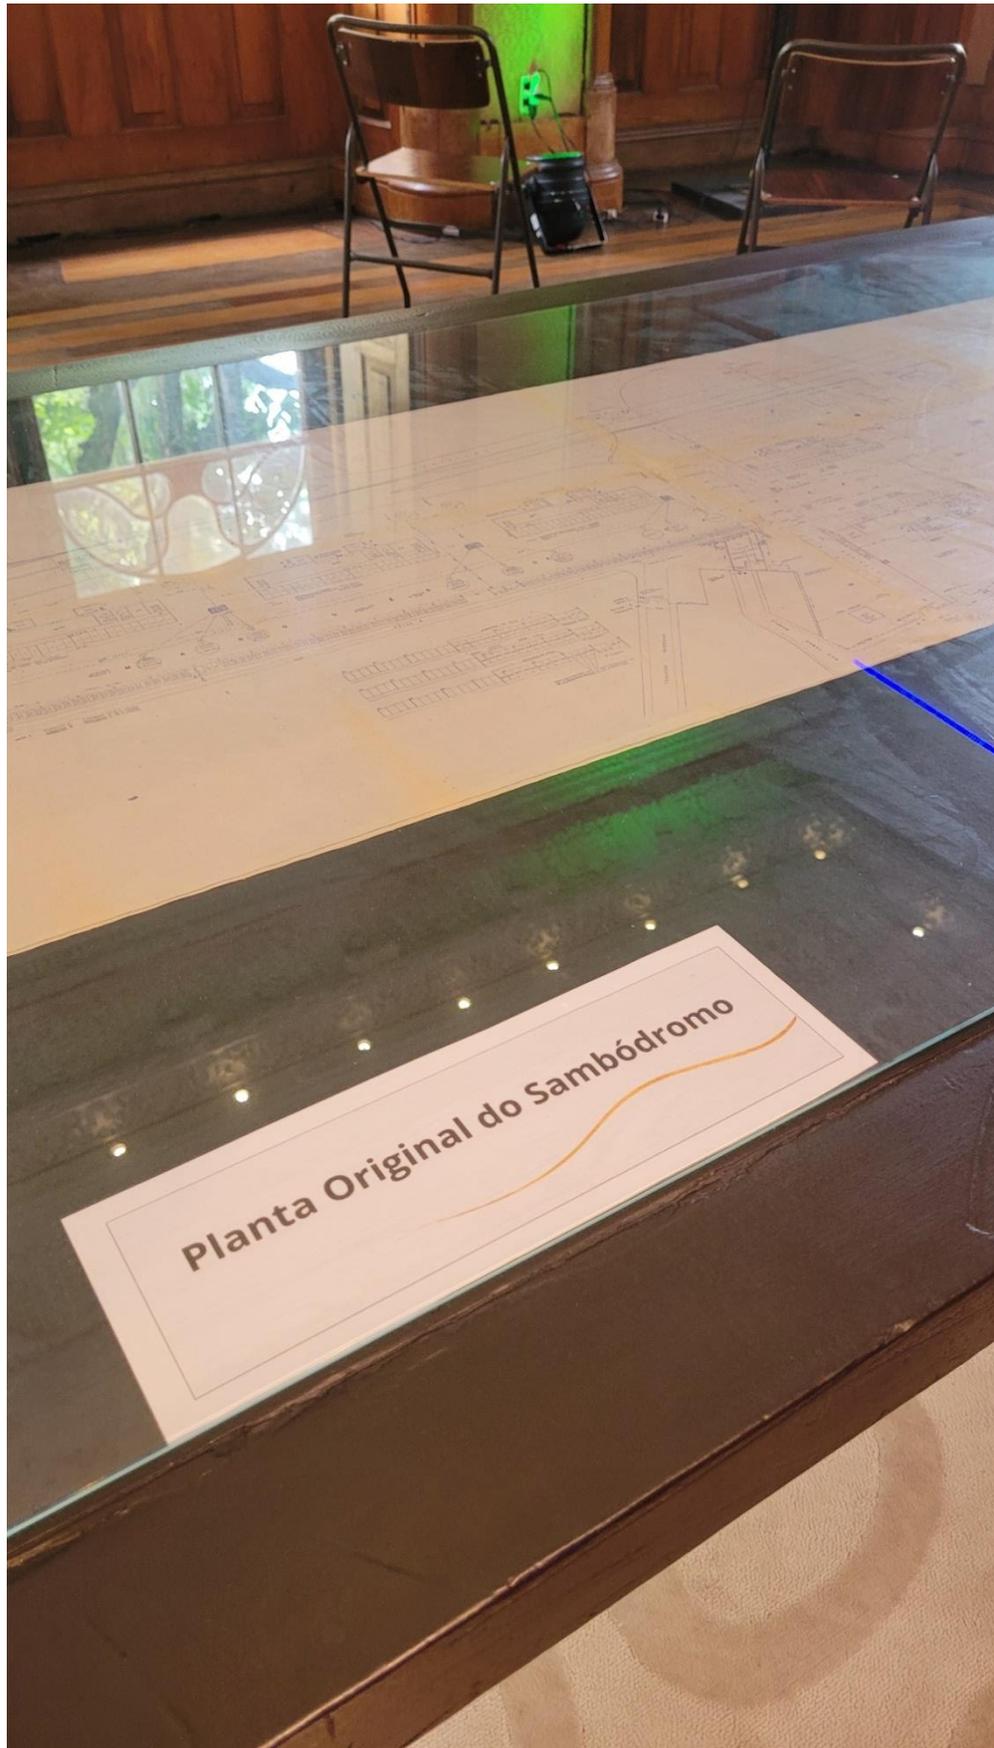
Planta original do Sambódromo do Rio de Janeiro.
